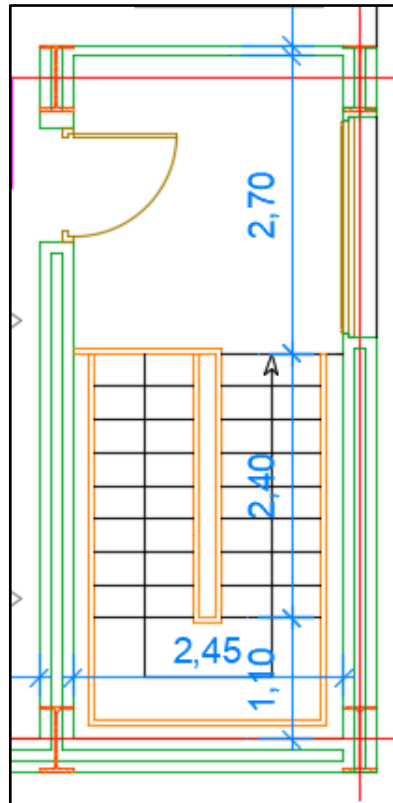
Vue en plan de l'escalier tirer du plan d'architecture
